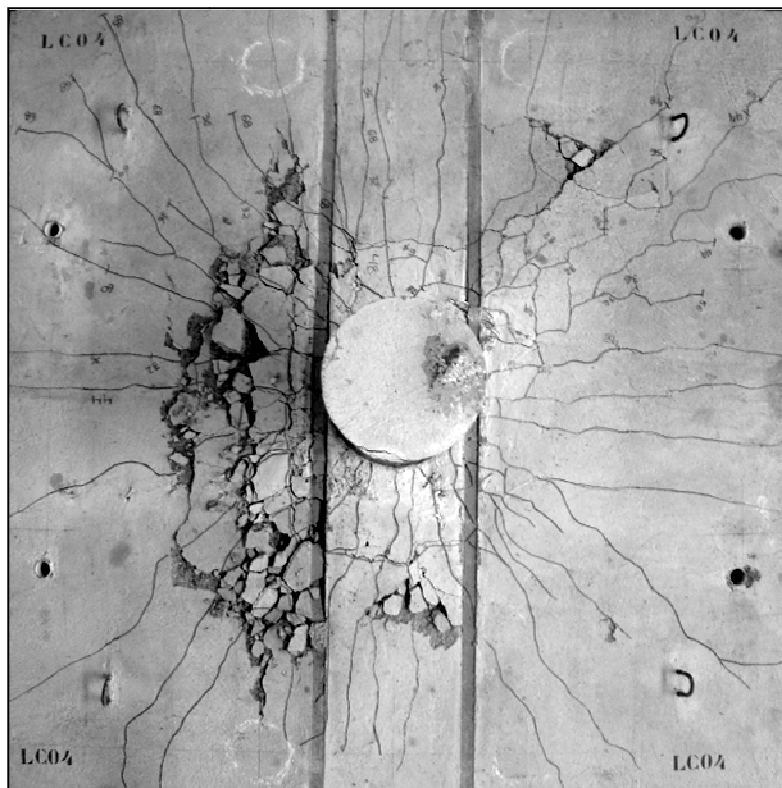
Mapa de fissuração da laje LC04
